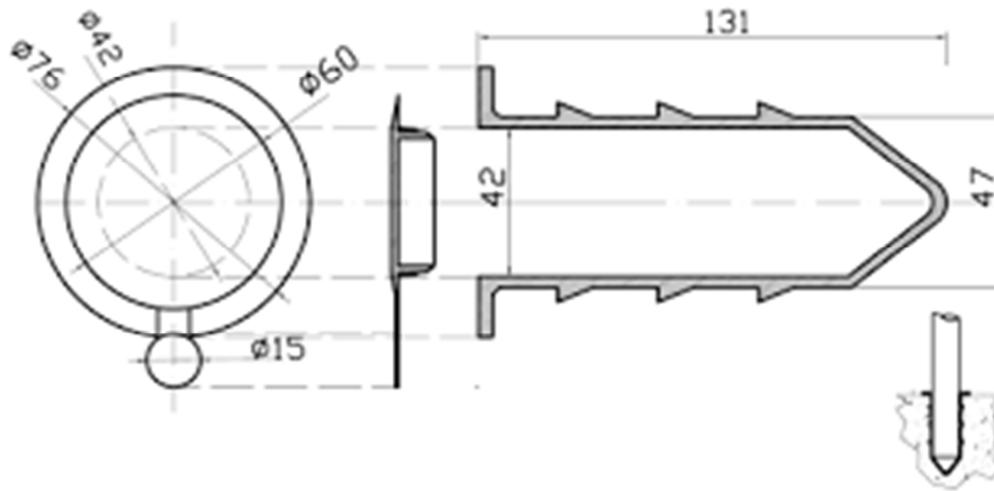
Detalle insertos para protección fija (baranda)
